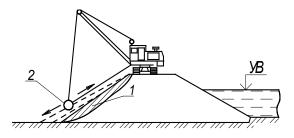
Схема отсыпки грунта наклонными слоями: I – укладываемый слой грунта; 2 – вальцовая трамбовка
